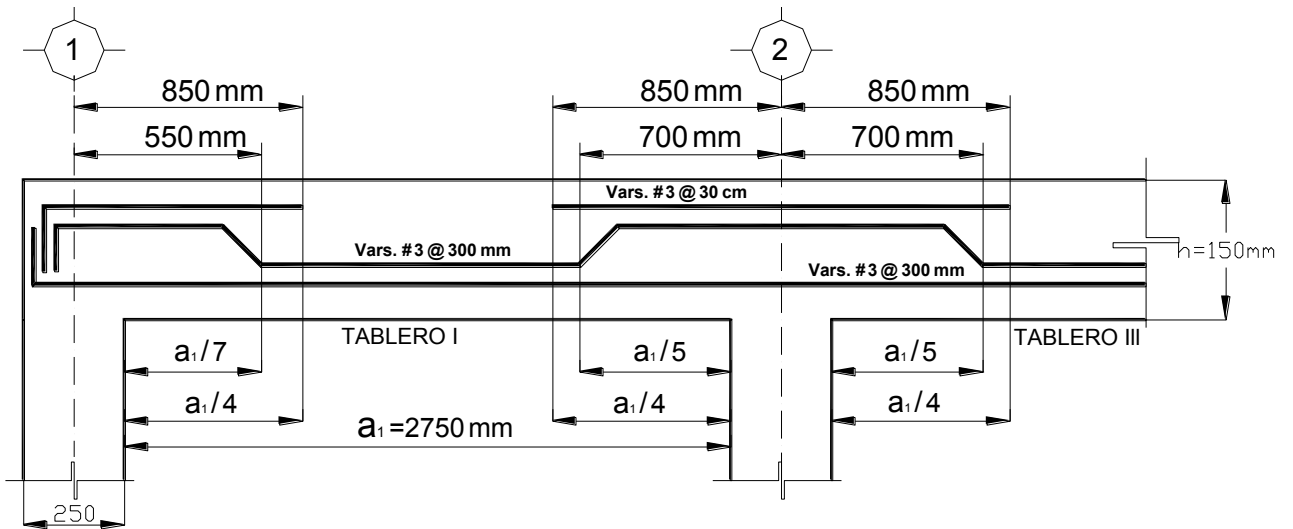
Corte longitudinal y transversal en la losa.
